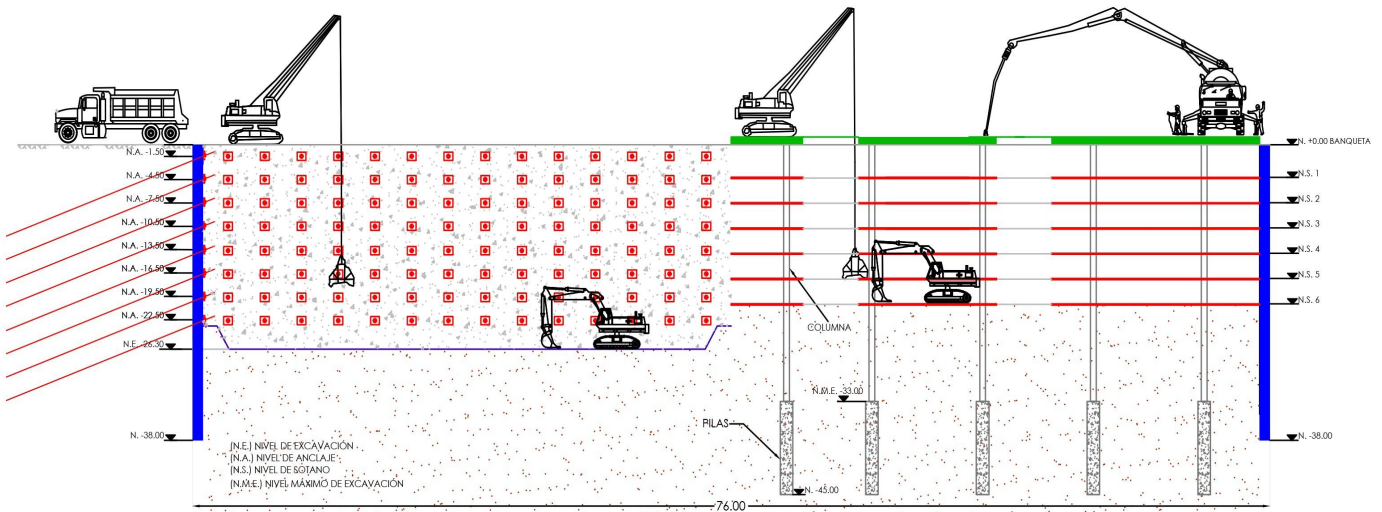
Excavación para ejecución del 8vo nivel de anclaje y 6to sótano.
